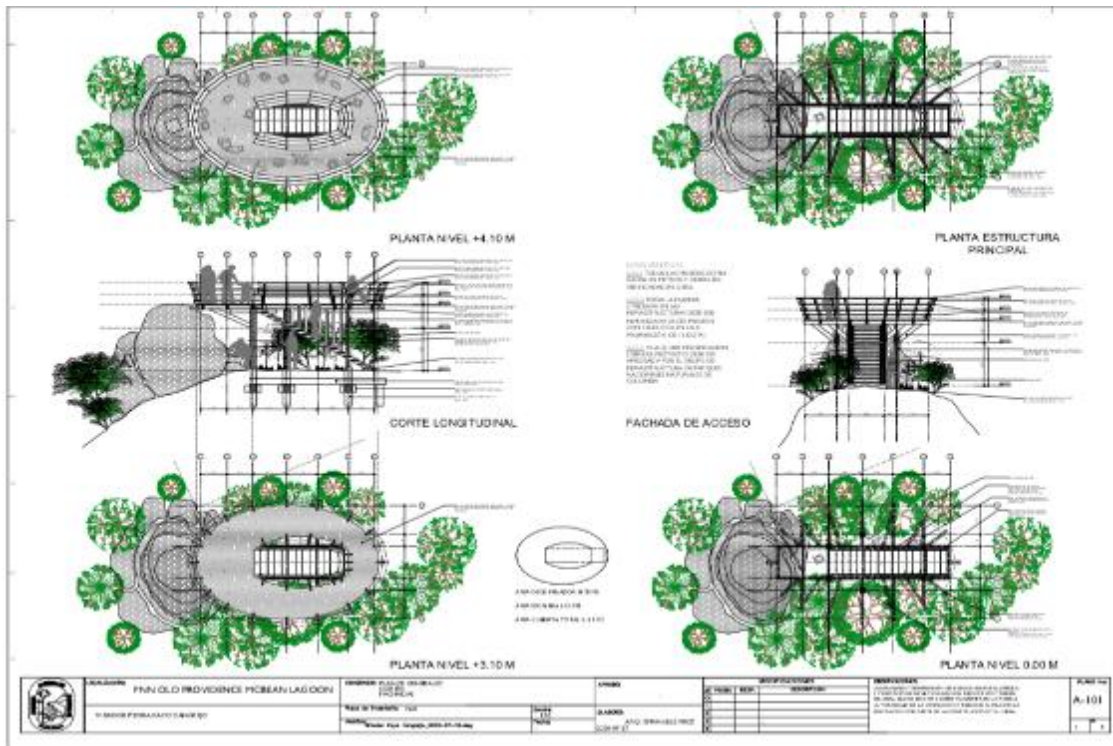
Plano arquitectónico referencial mirador Fuente: GI - PNNC
